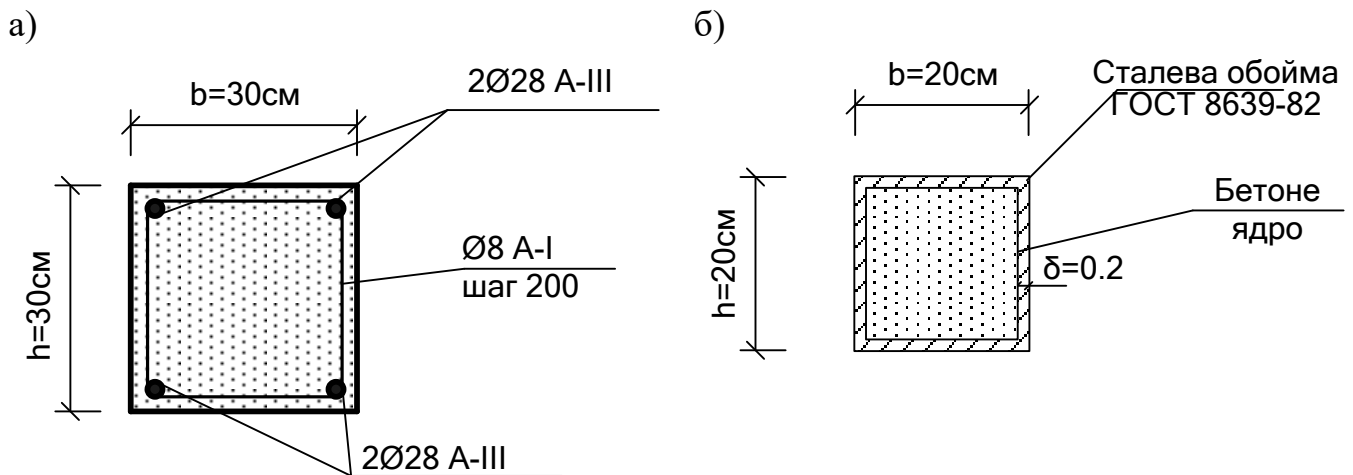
Геометричні розміри колон: а) - залізобетонна колона; б) - сталобетонна колона
